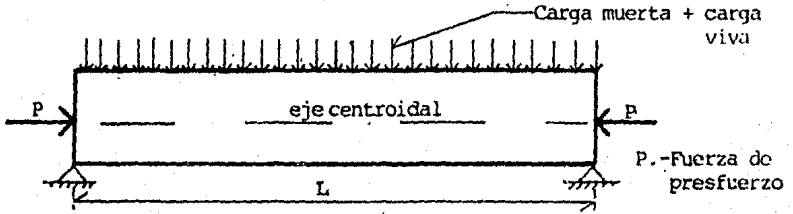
Viga de sección rectangular con una fuerza de presfuerzo aplicada concéntricamente y una carga aplicada transversalmente.
